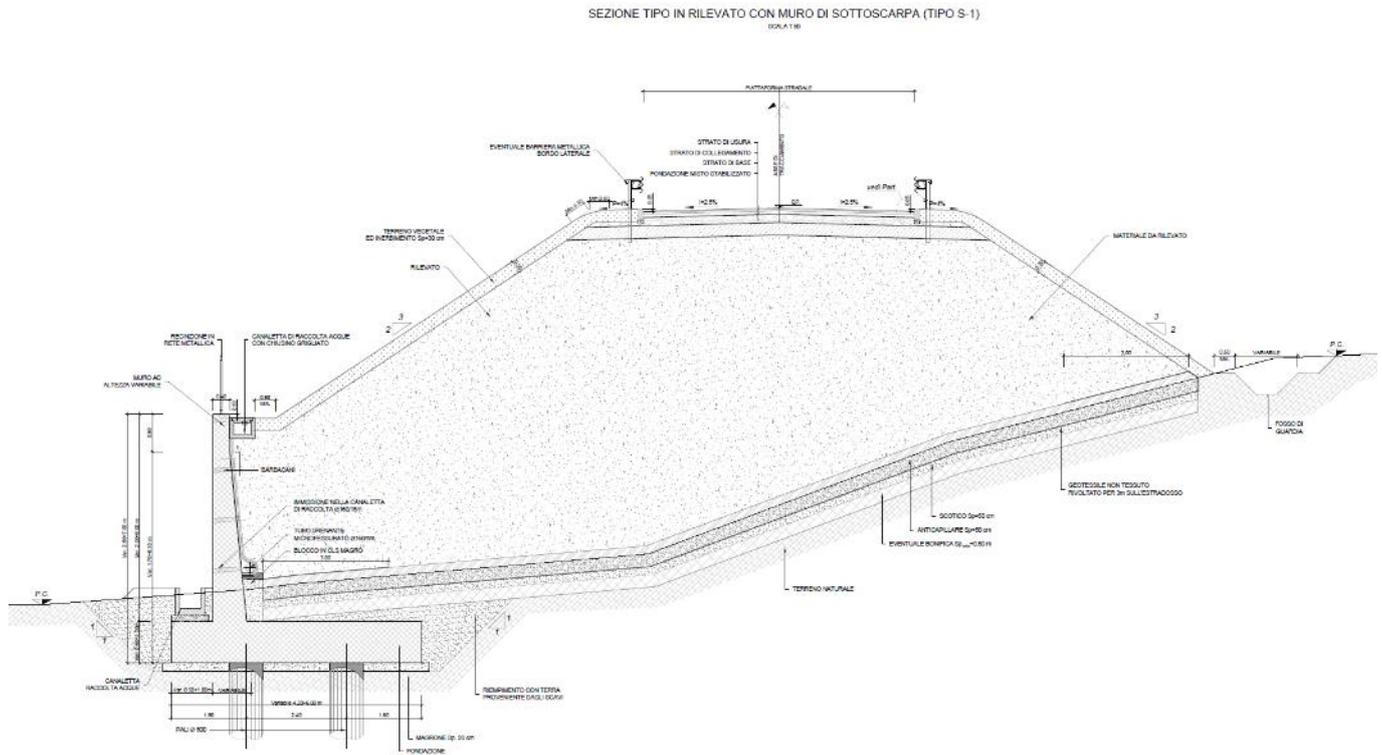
Sezione tipo in rilevato con muro di sottoscarpa (tipo S-1)
